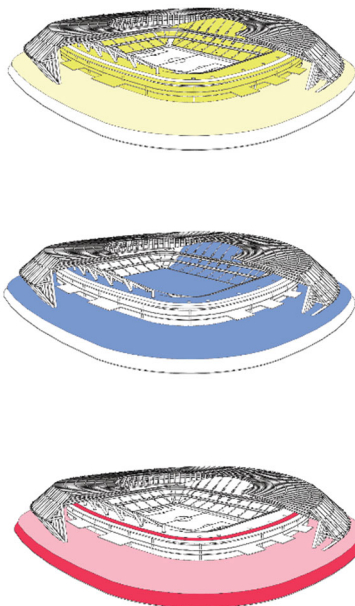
Planta -1 vinculo comercio soterrado- Planta Urbana
